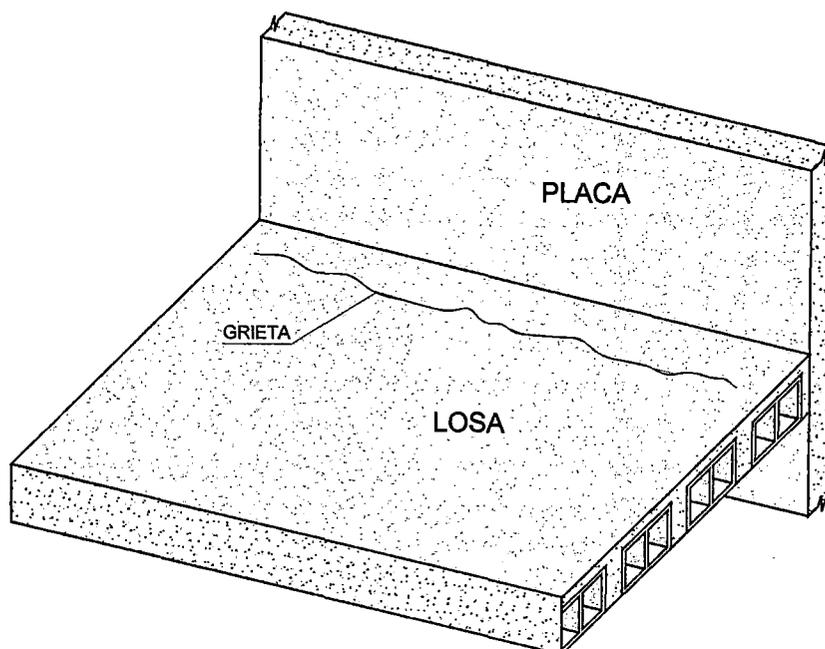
Agrietamiento por contracción por secado en losa aligerada.
